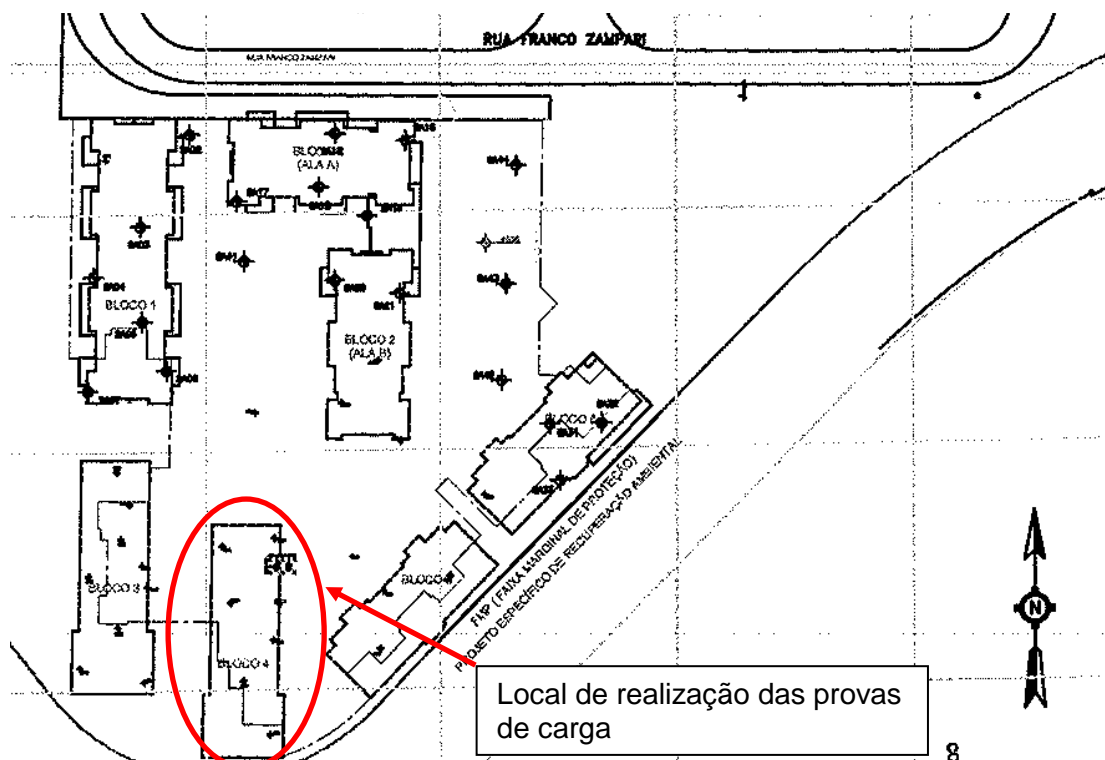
Planta de situação com a localização dos furos da sondagem a percussão.
